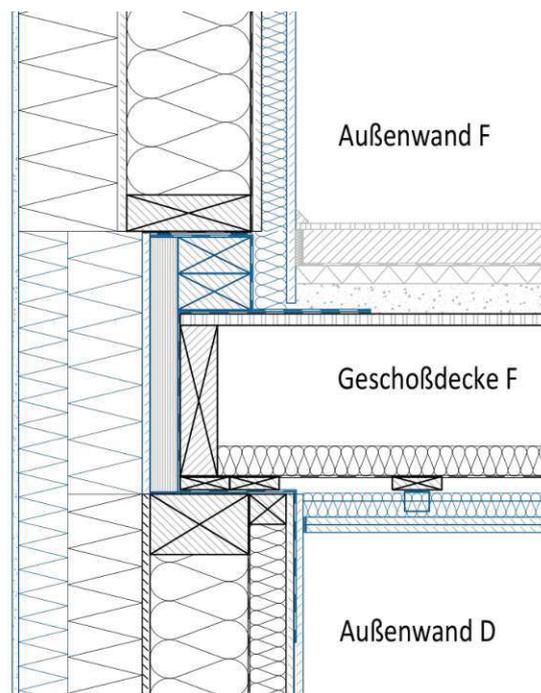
Bauteilfügung Außenwand D – Geschoßdecke F – Außenwand F (Quelle: eigene Darstellung)
